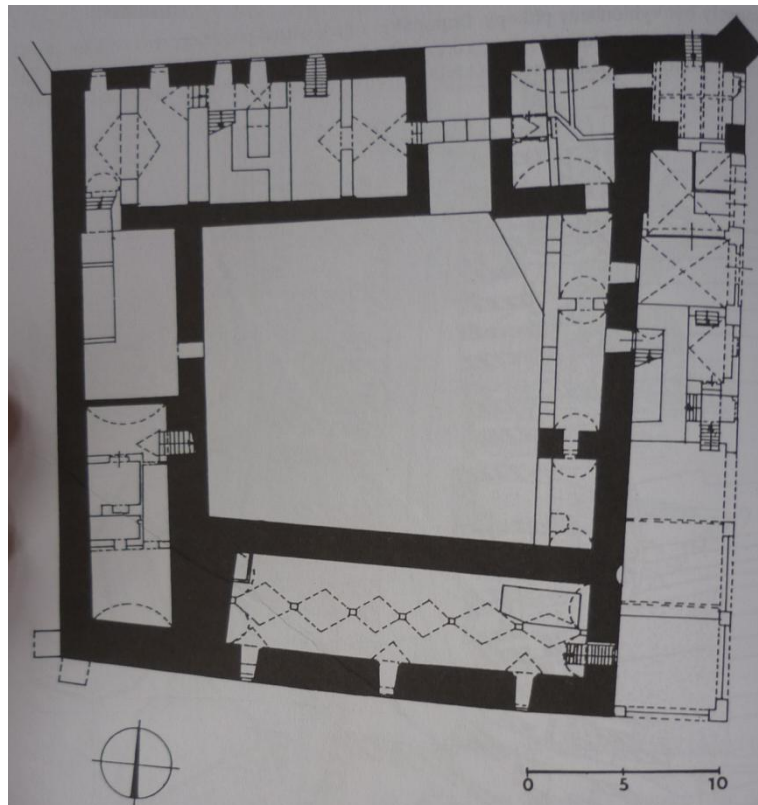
Písek, rekonstrukce půdorysu patra hradu v 13. století. 1 – Dochované zdivo
